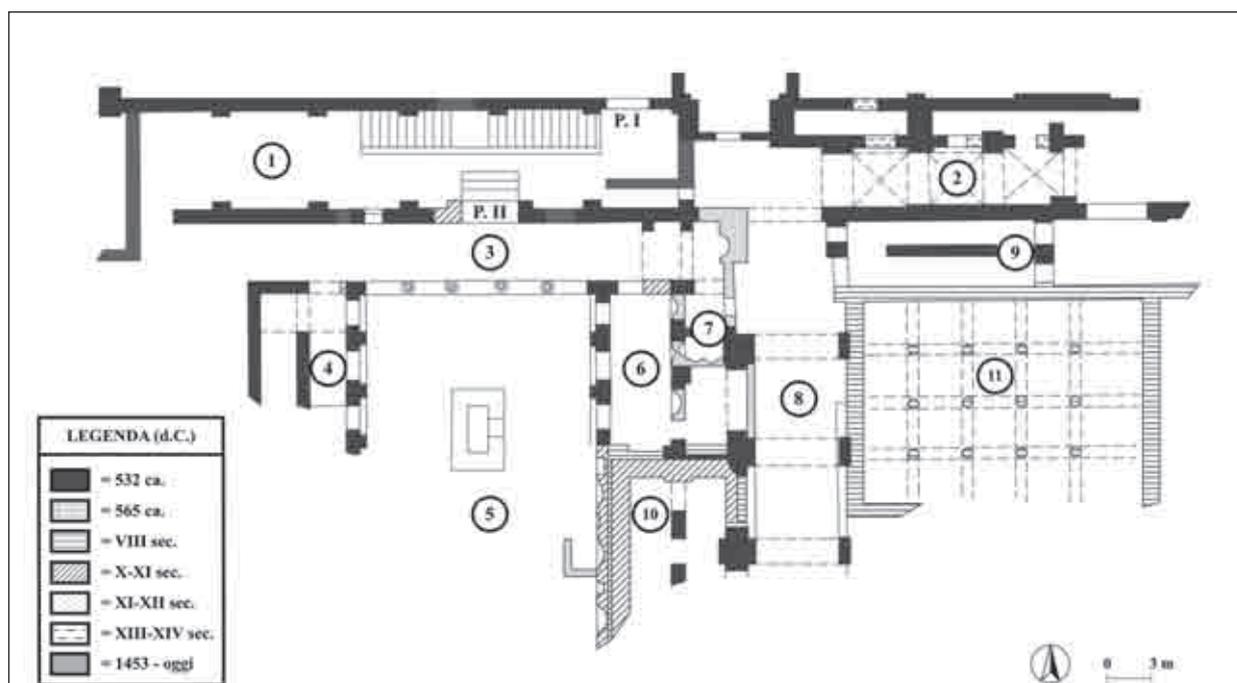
Planimetria dello scavo (illustrazione dell'Autore)
